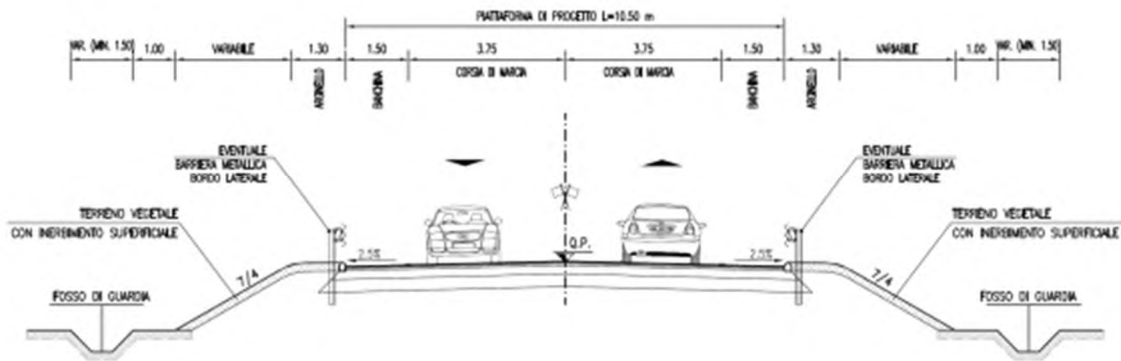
Sezione tipo rampa di svincolo bidirezionale
